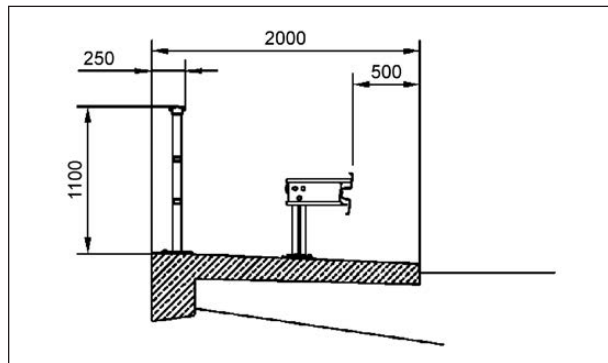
Querschnitt EDSP 1.33 BW+ mit Geländer
